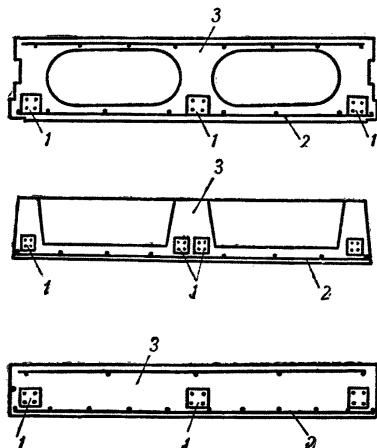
Примеры сечений сборных конструкций, армированных предварительно напряженными элементами
